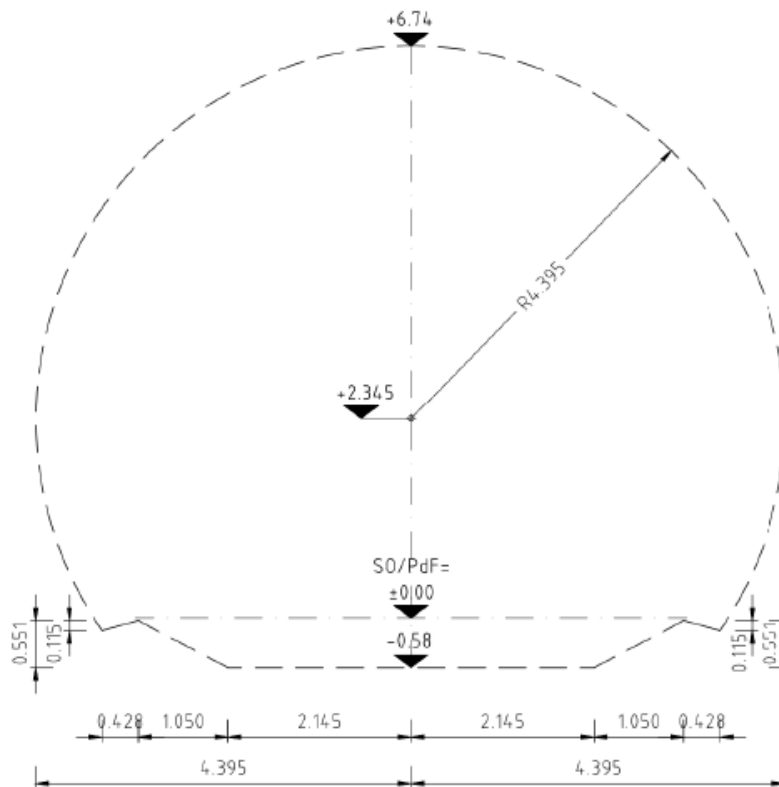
Mindestprofil – Haupttunnel, Aushub mit kontinuierlichem Vortrieb und einz4elen Schale (Ein-Doppelschild TBM).
